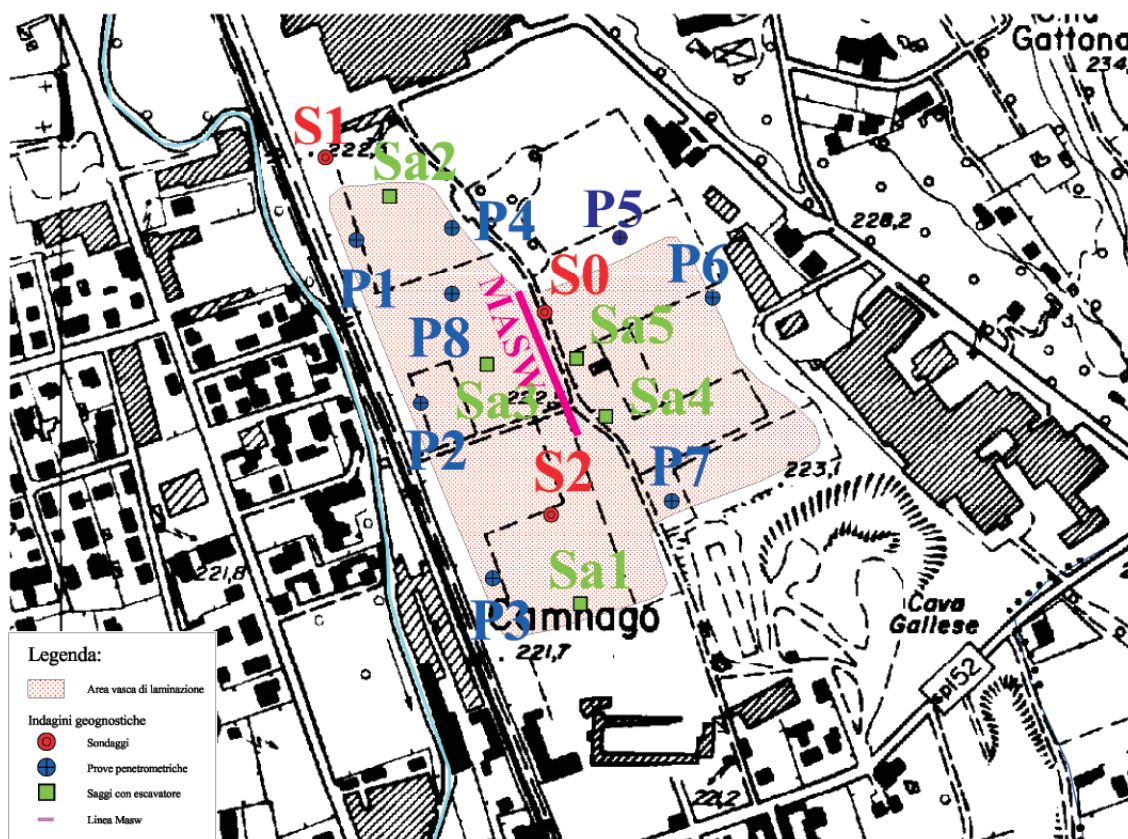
Planimetria con indicazione dei saggi e delle prove effettuate.
